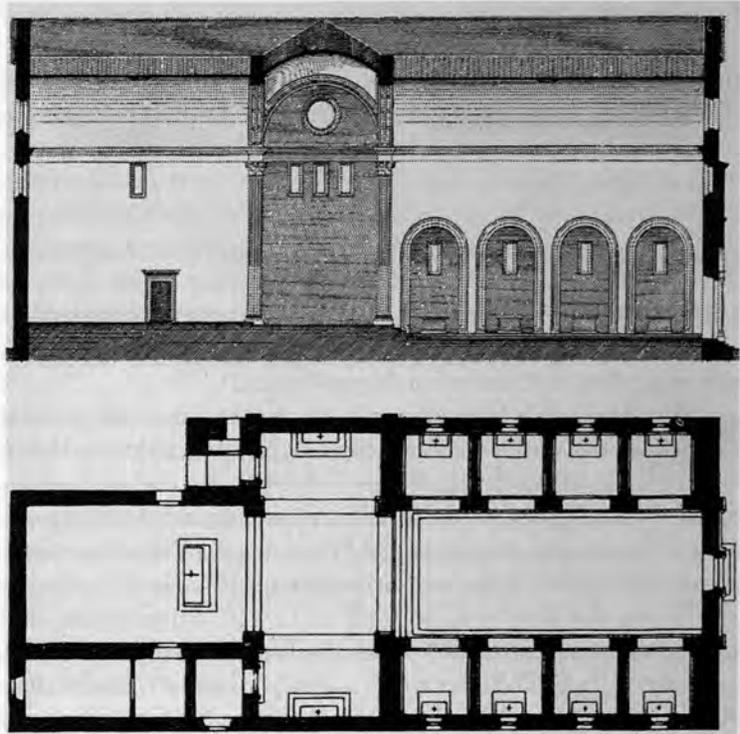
Badia Fiesolana, Grundriß und Längsschnitt (nach P. Laspeyres 1882)
